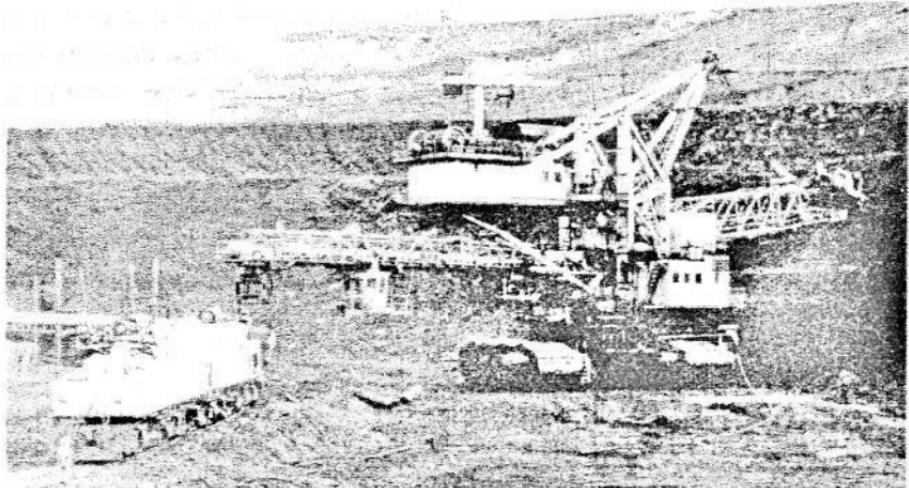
Роторный экскаватор ЭРГ-400ДЦ с центробежной разгрузкой ковшей
